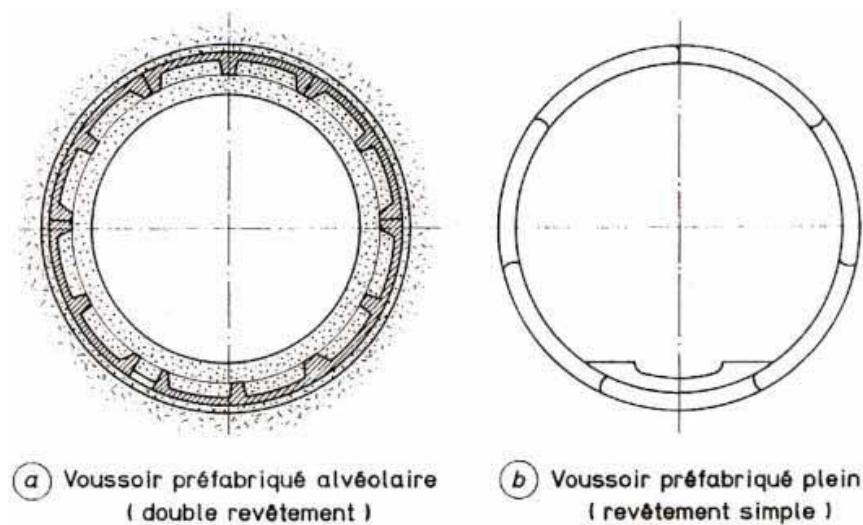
Voussoirs préfabriqués en béton armé [8]
